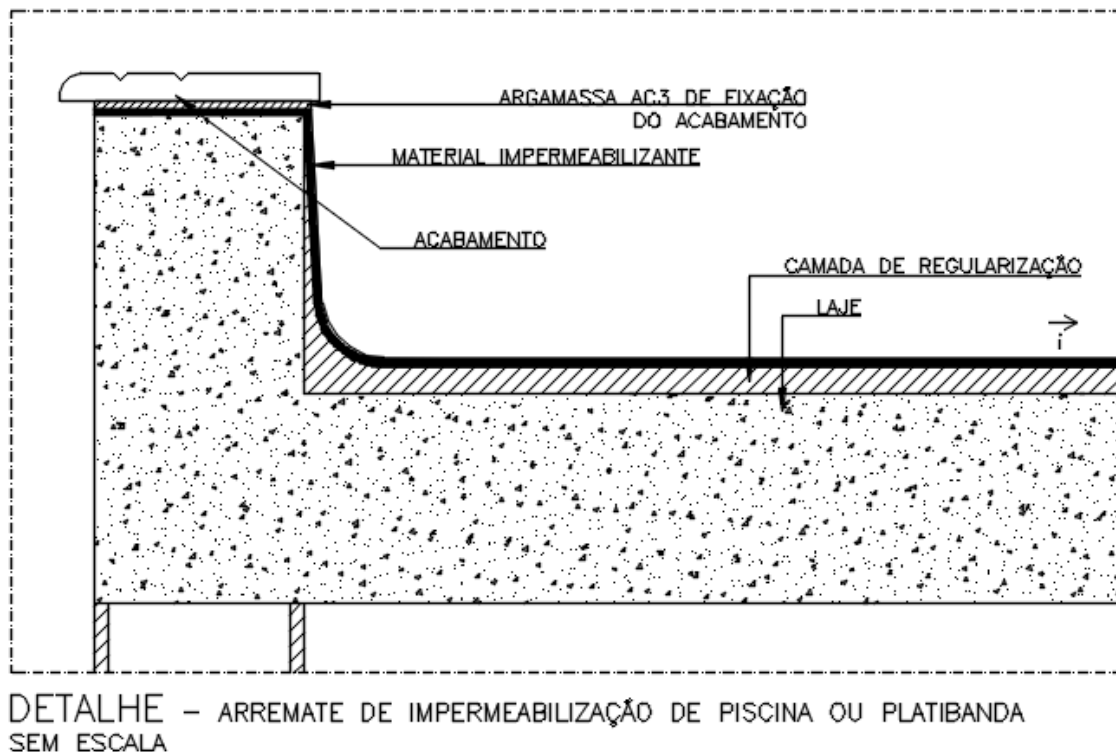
Arremate de bordas de piscina ou platibanda. Fonte: Elaboração própria.
